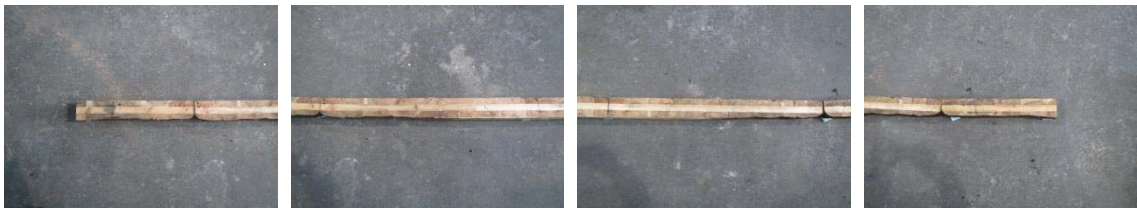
試験後の断面状況（断面Ⅲ）
